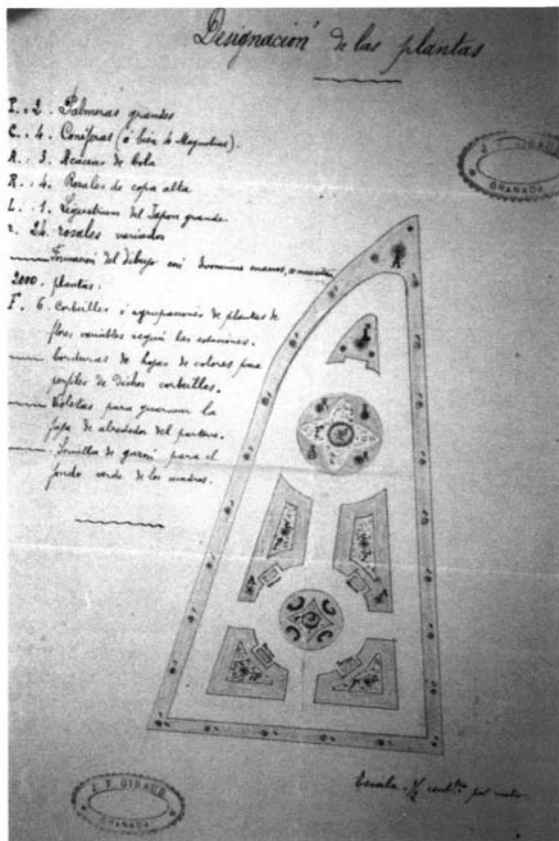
Plaza de Santa Ana. Plano de designación de las plantas. Sello de J.F. Giraud. Granada. A.H.M.C. Obras públicas. Leg. 1090.
